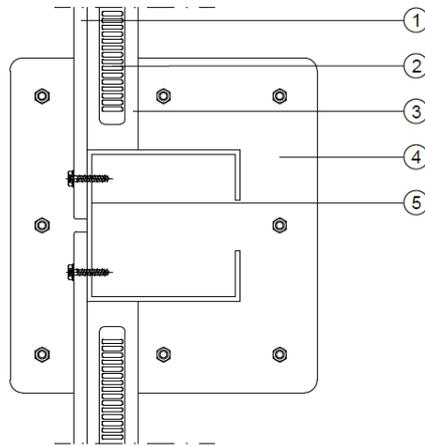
Dettaglio tipologico installazione cor-ten – Pianta - Connessione lineare
